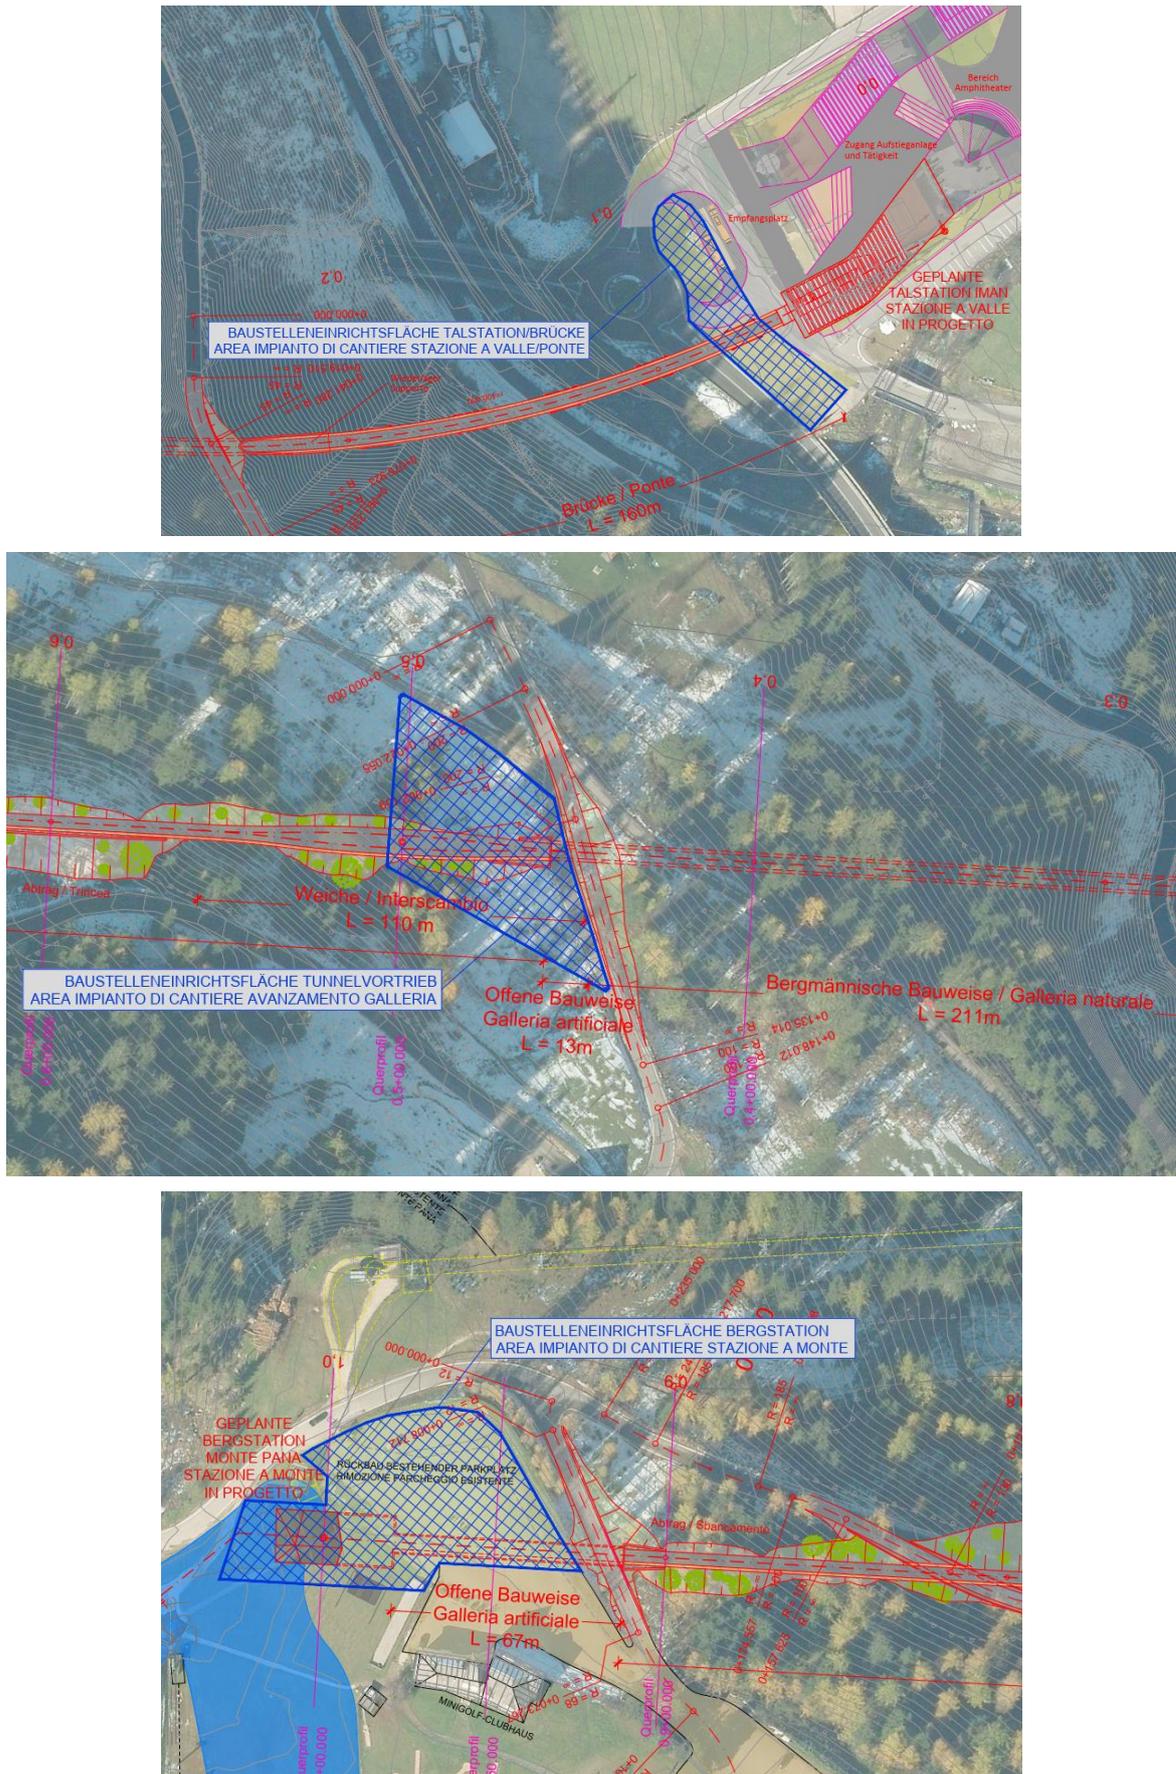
Geplante Baustelleneinrichtungsflächen (Talstation, Südportal bergm. Tunnel, Bergstation)
